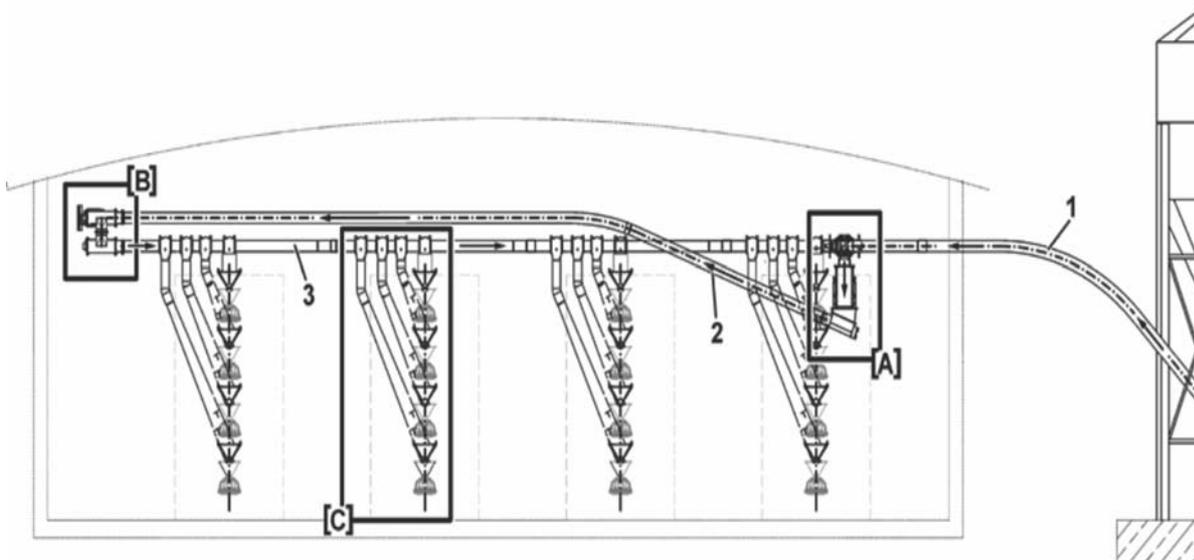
Vue d'ensemble de la ligne Flex-Vey
